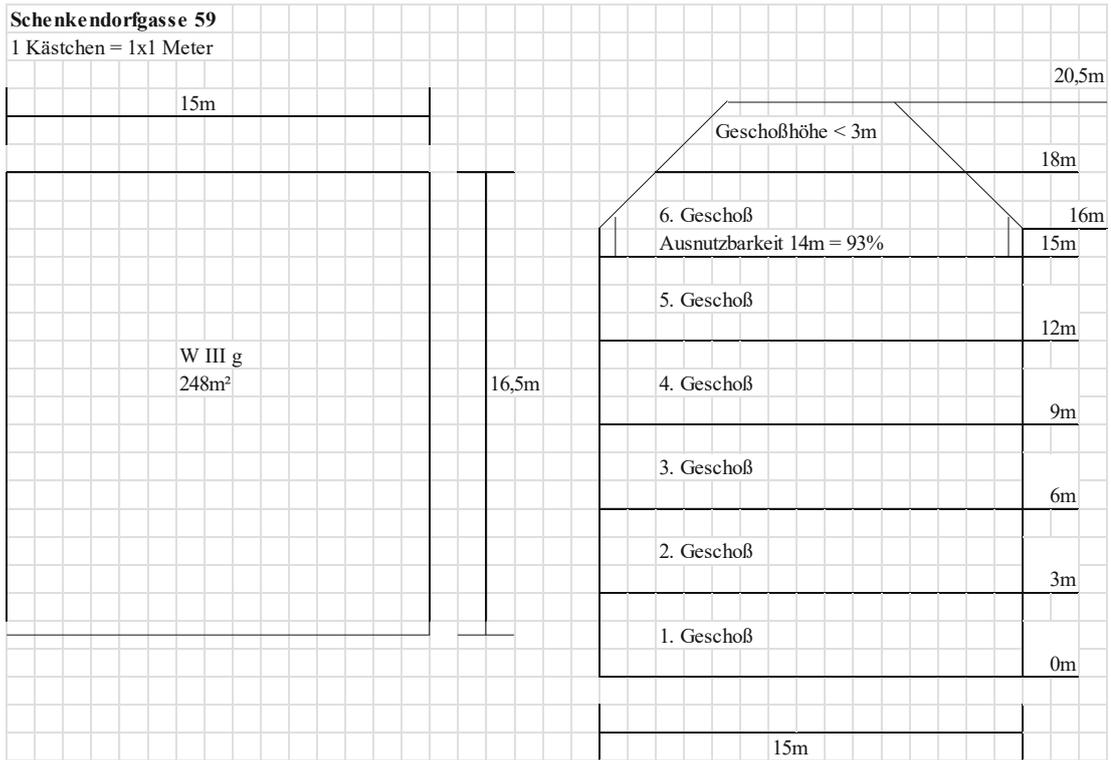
Visualisierung der bebaubaren Grundfläche und der erzielbaren Geschoßanzahl (Eigene Darstellung, 2022)
